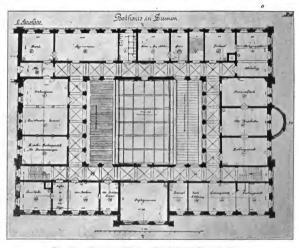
Hauptpostgebäude. Grundrifs des Hauptgeschosses.
